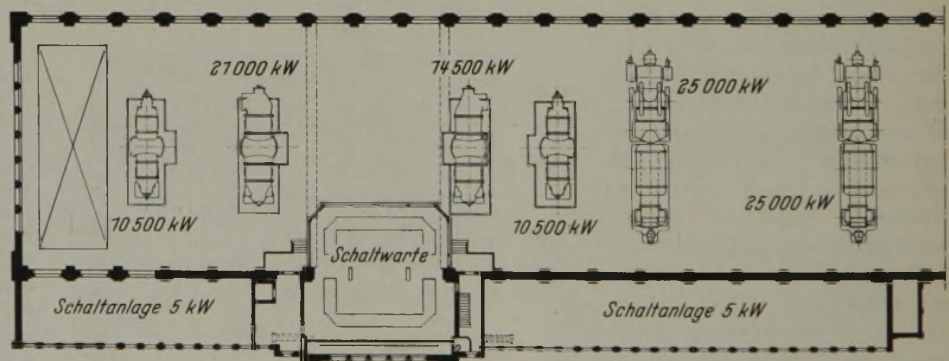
Grundriß der Maschinenhalle und Schaltwarte mit Schaltanlagen.
